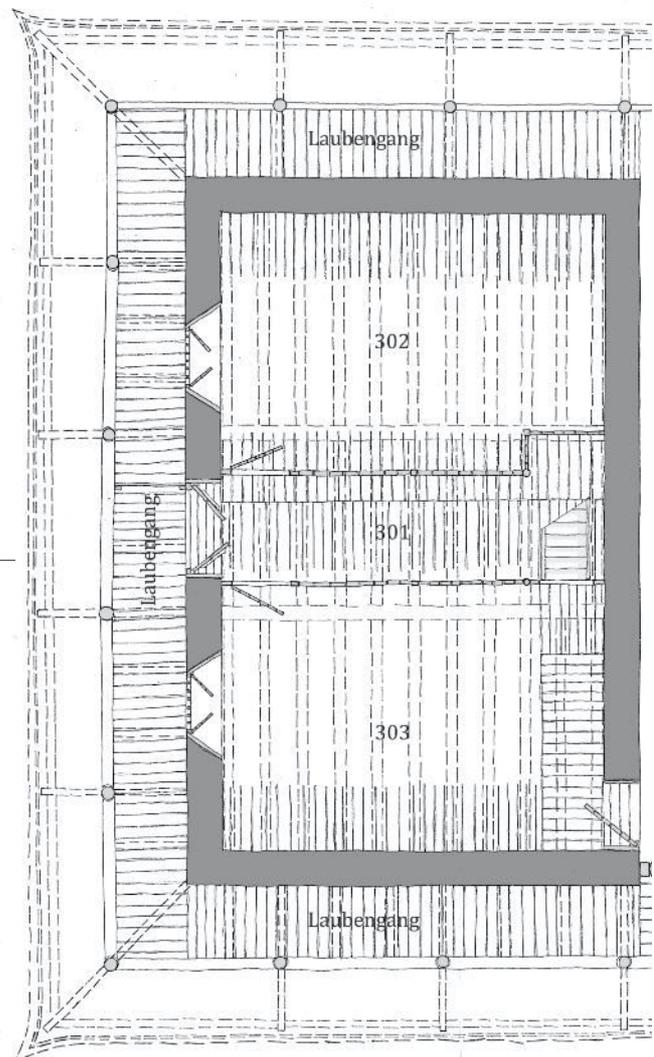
Grundriss Wachturm (3. OG), M 1:100
